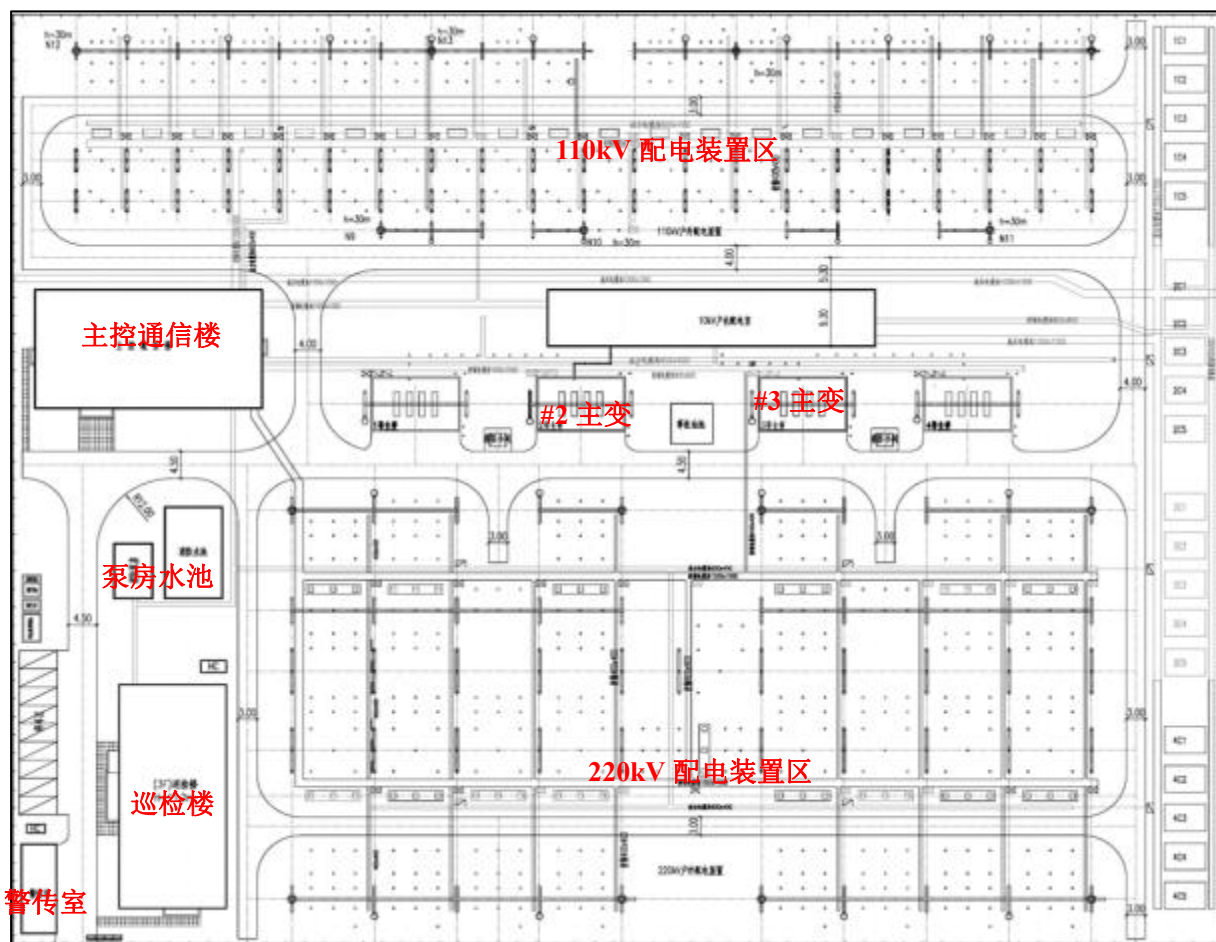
220 千伏华韶站总平面布置示意图
